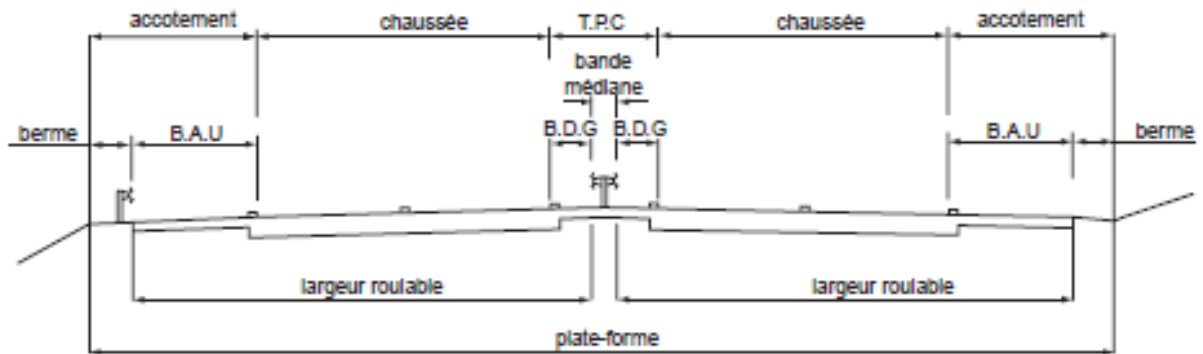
Élément constitutif d'un profil en travers en section courante.
